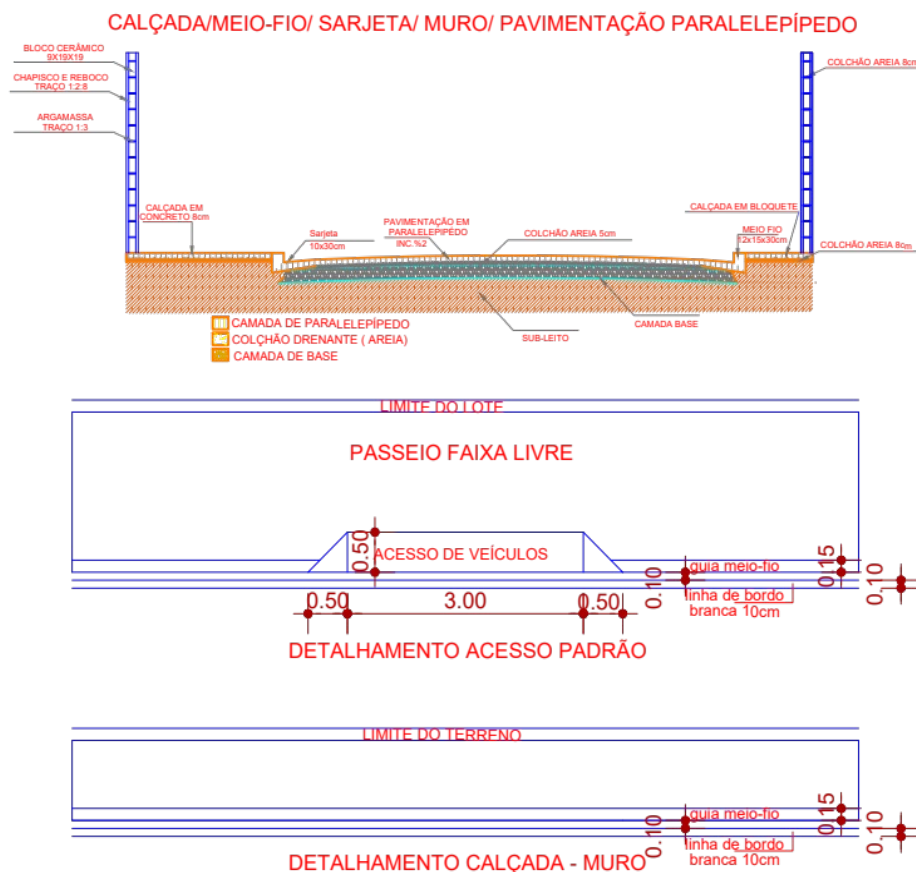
Etapas para recuperação de calçada, meio-fio, sarjeta, muro e pavimentação em paralelepípedo.
